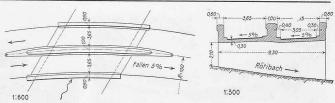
Eisenbetonbrücke über den Rötibach. Abgestufter Fahrbahnquerschnitt wegen geringer Bauhöhe.
